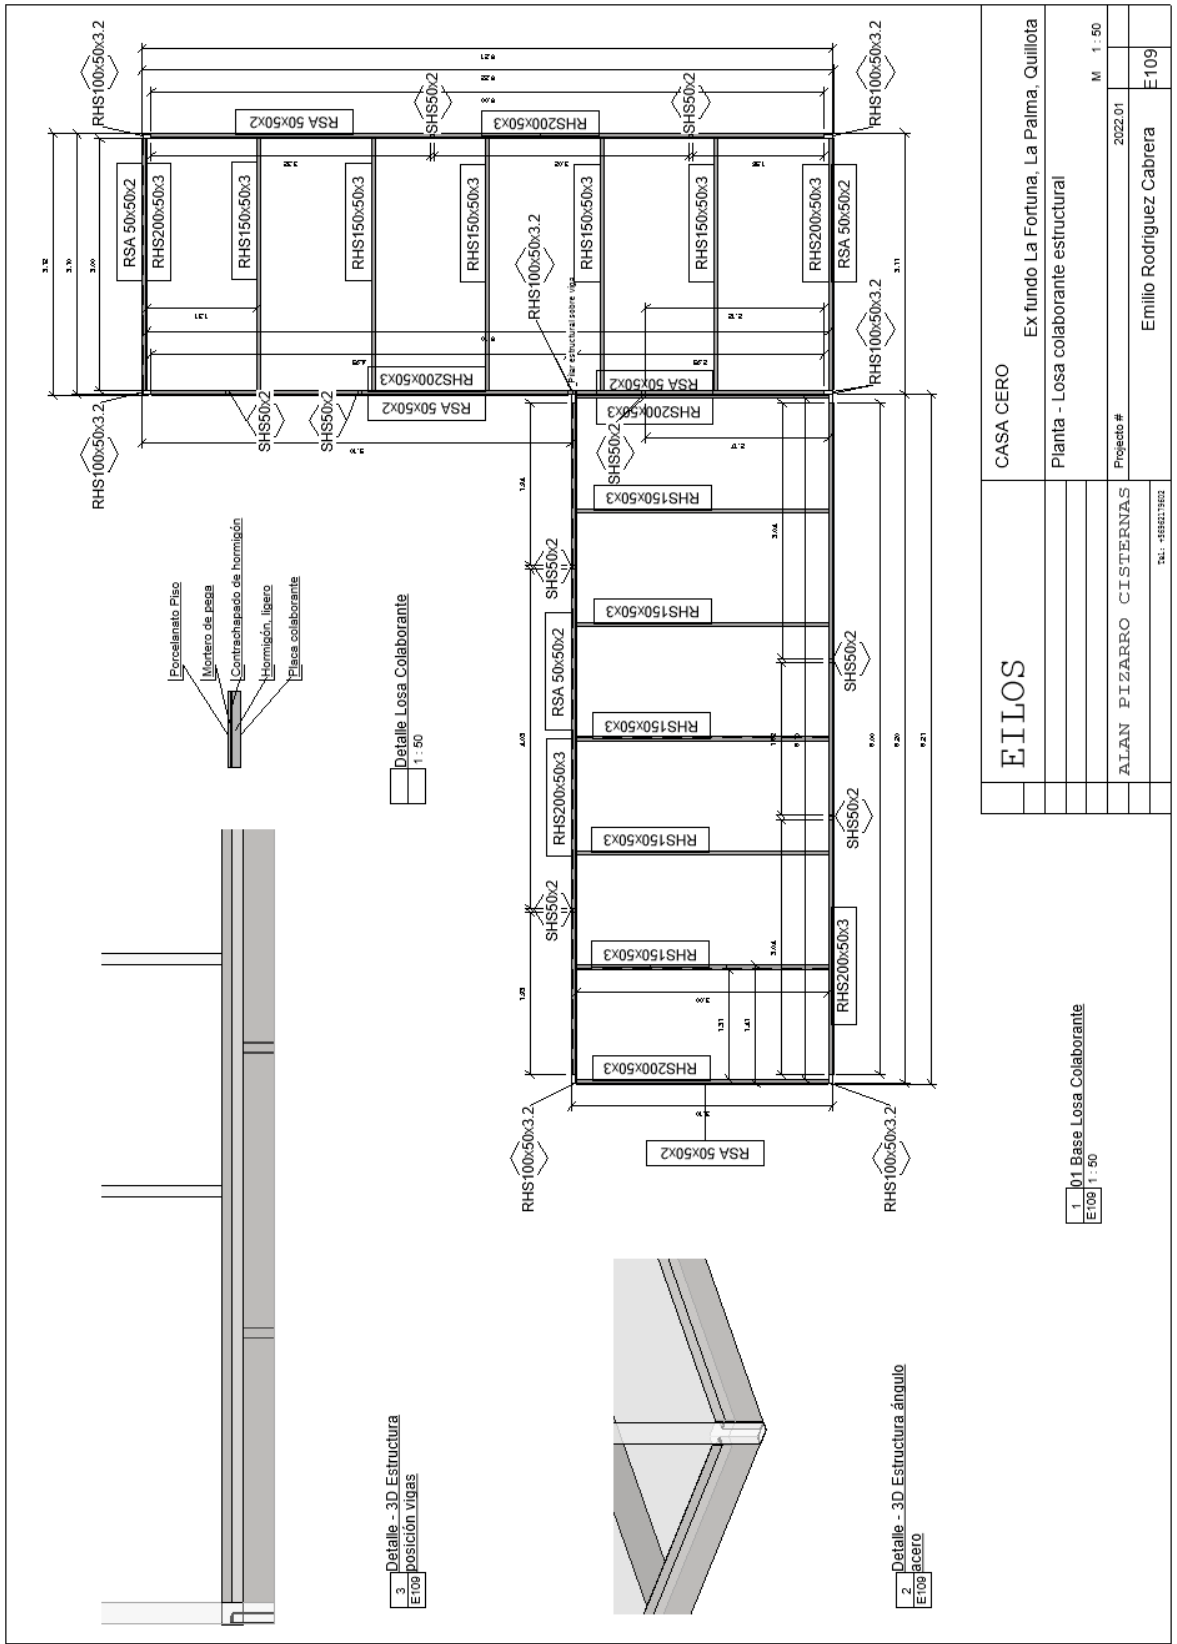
Plano de Losa Colaborante Incluye Detalles.
